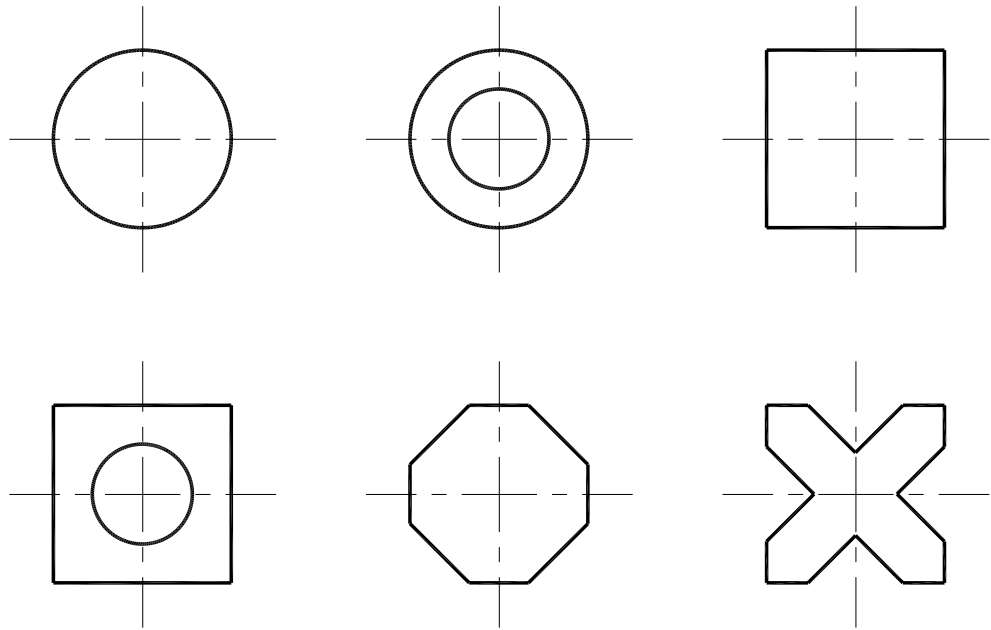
Сечения сжатых железобетонных элементов, сжатых со случайными эксцентриситетами.
